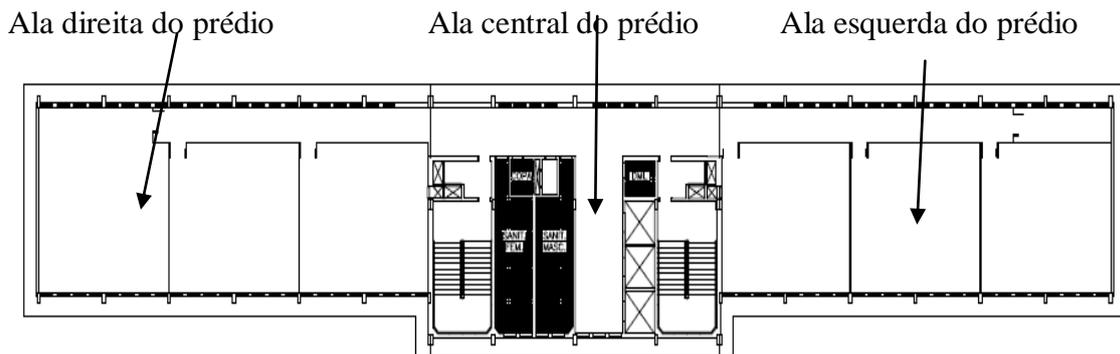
Planta baixa do pavimento tipo, contendo a ala central de serviços e duas alas laterais de salas de aula, administração e circulação do prédio do bloco “O”
